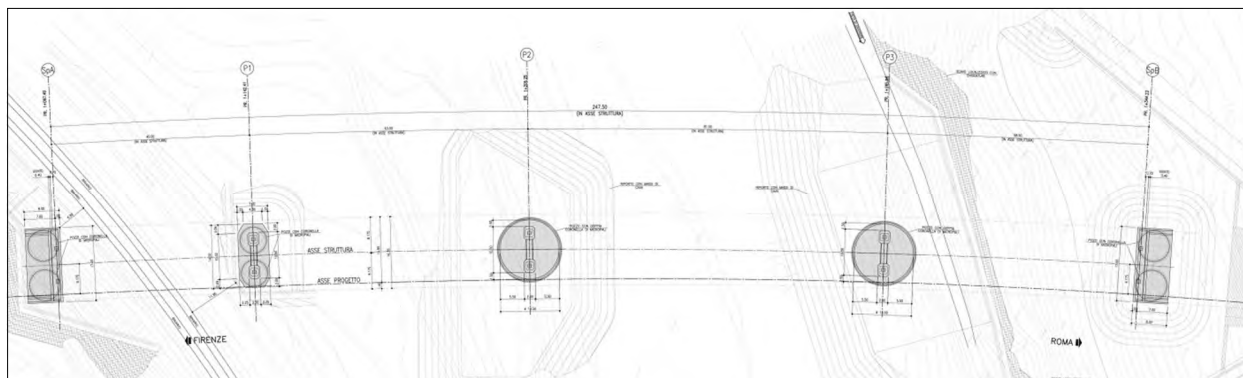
Pianta delle fondazioni (stralcio planimetrico da elab. STR5501)
